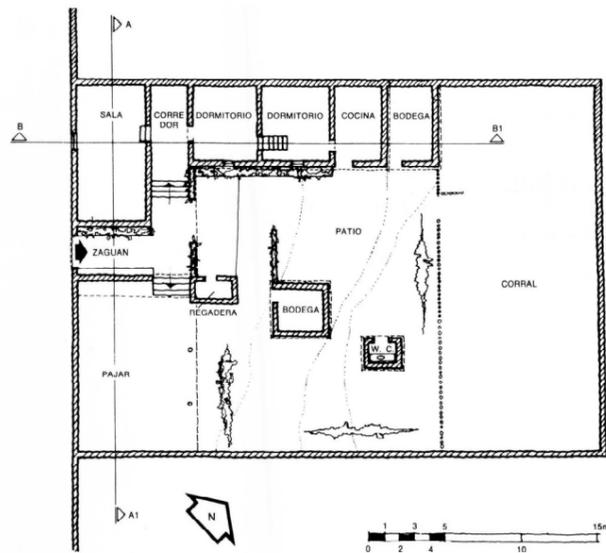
Grundriss eines Hauses mit Wohnräume um einen Patio, Mexiko
